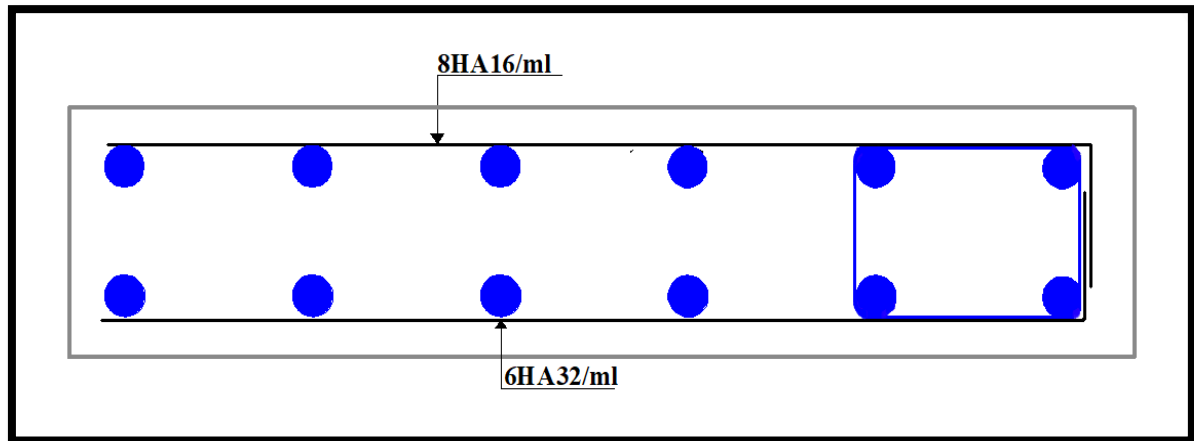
Vue en coupe transversale du ferrailage de la culée
